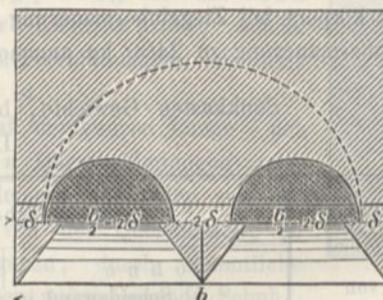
und 6 zeigen eine derartige Construction, wie sie ähnlich bei dem Senkkasten für das Widerlager der neuen Alexanderbrücke über die Newa zu St. Petersburg ausgeführt ist.*)
